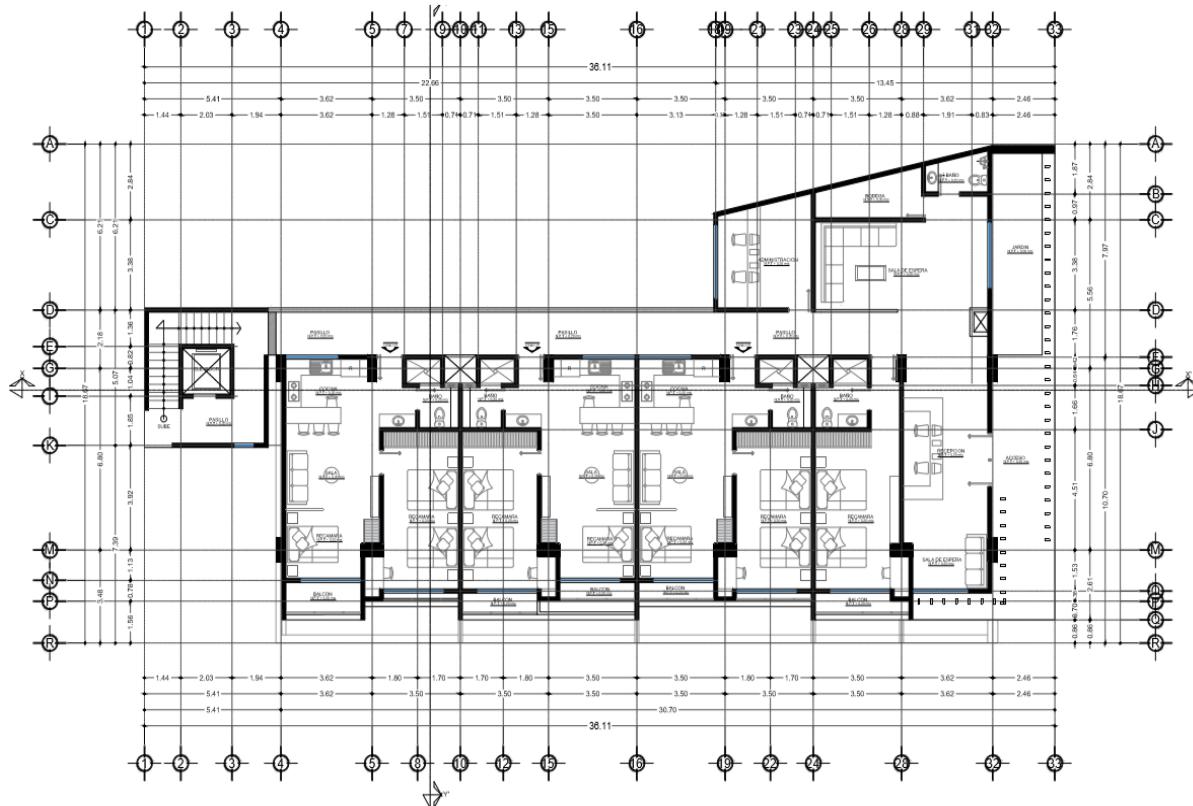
Planta arquitectónica de planta baja del Edificio B.
